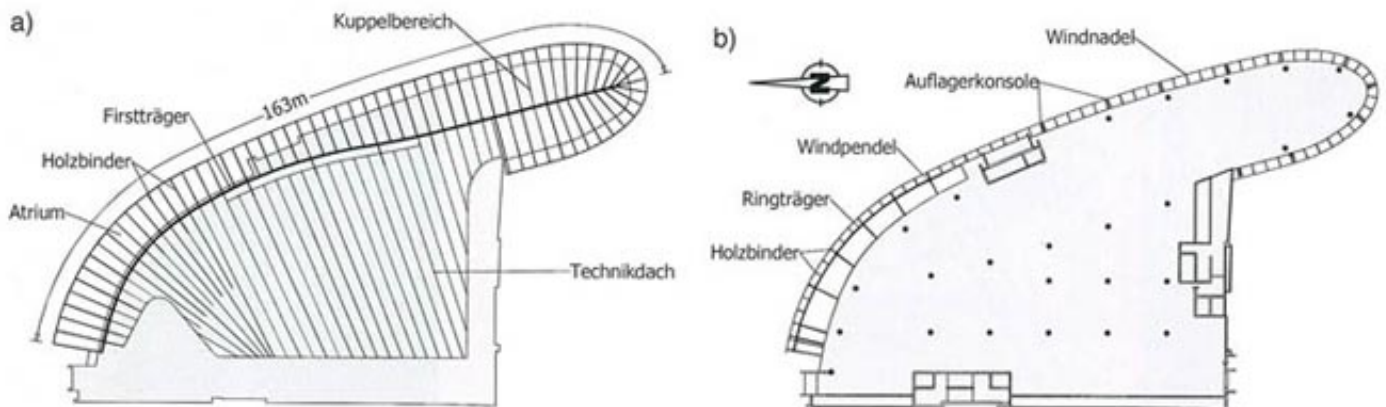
a) Aufsicht Fassade, b) Horizontalschnitt im 4. OG, Lagerung der Konstruktion
